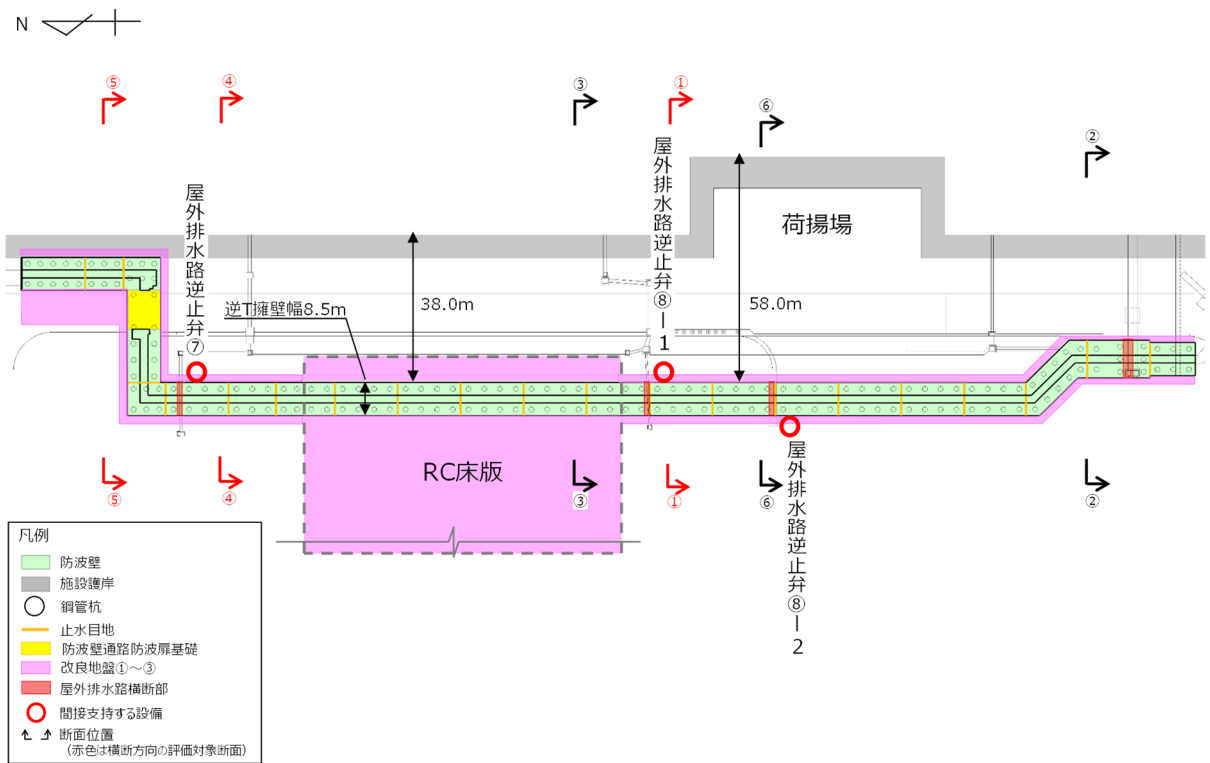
評価対象断面（横断方向）の平面位置図
